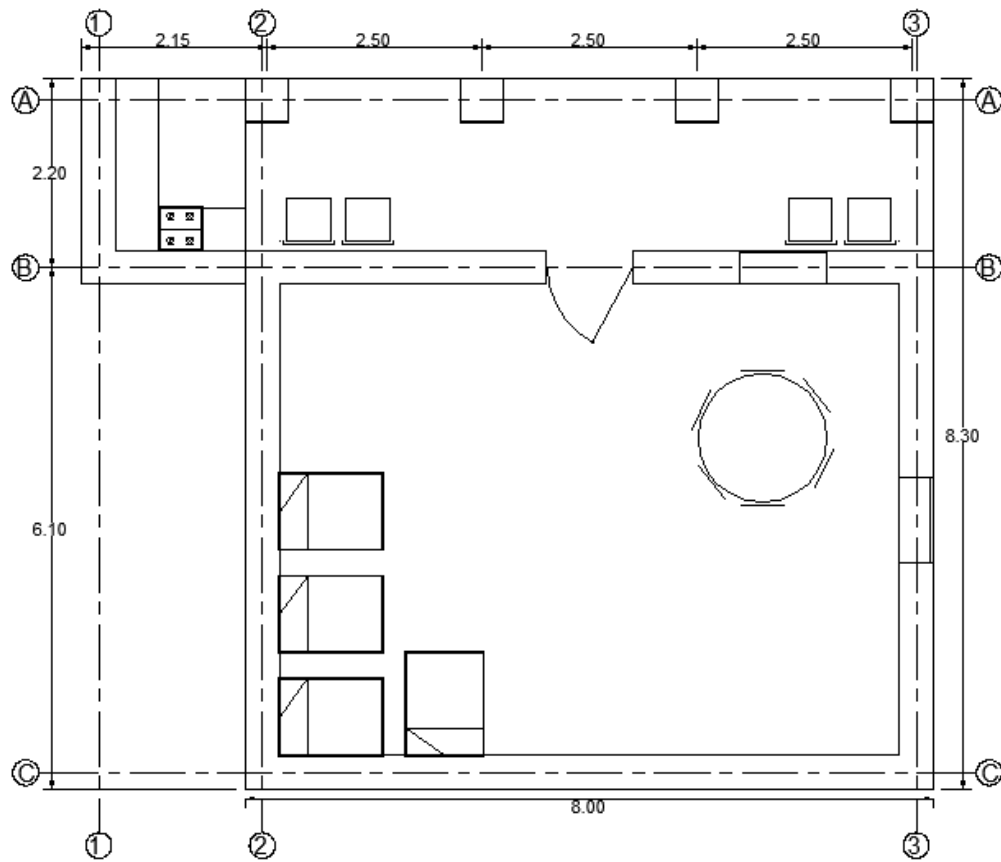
Planta de vivienda tipo de Adobe en El Salvador
